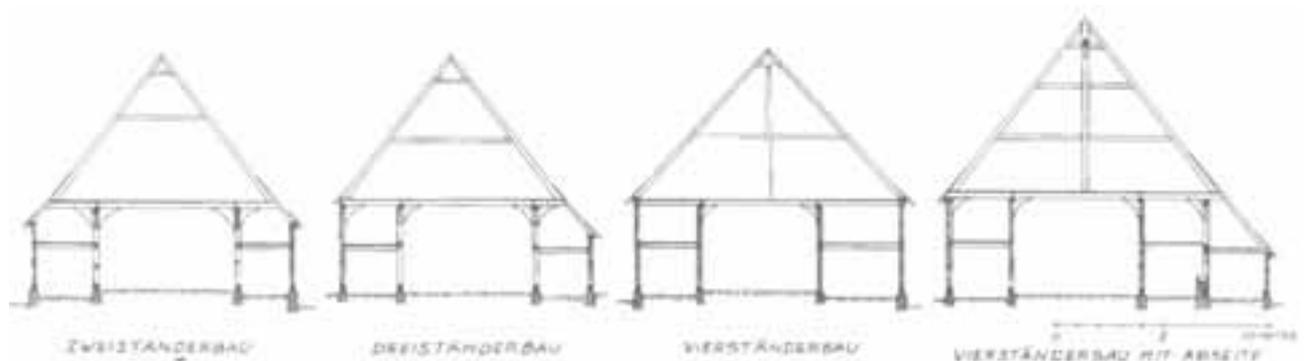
Gerüstformen des niederdeutschen Hallenhauses
